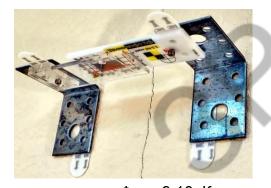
,10. Конструкція багаторазового (інвентарного) маяка
